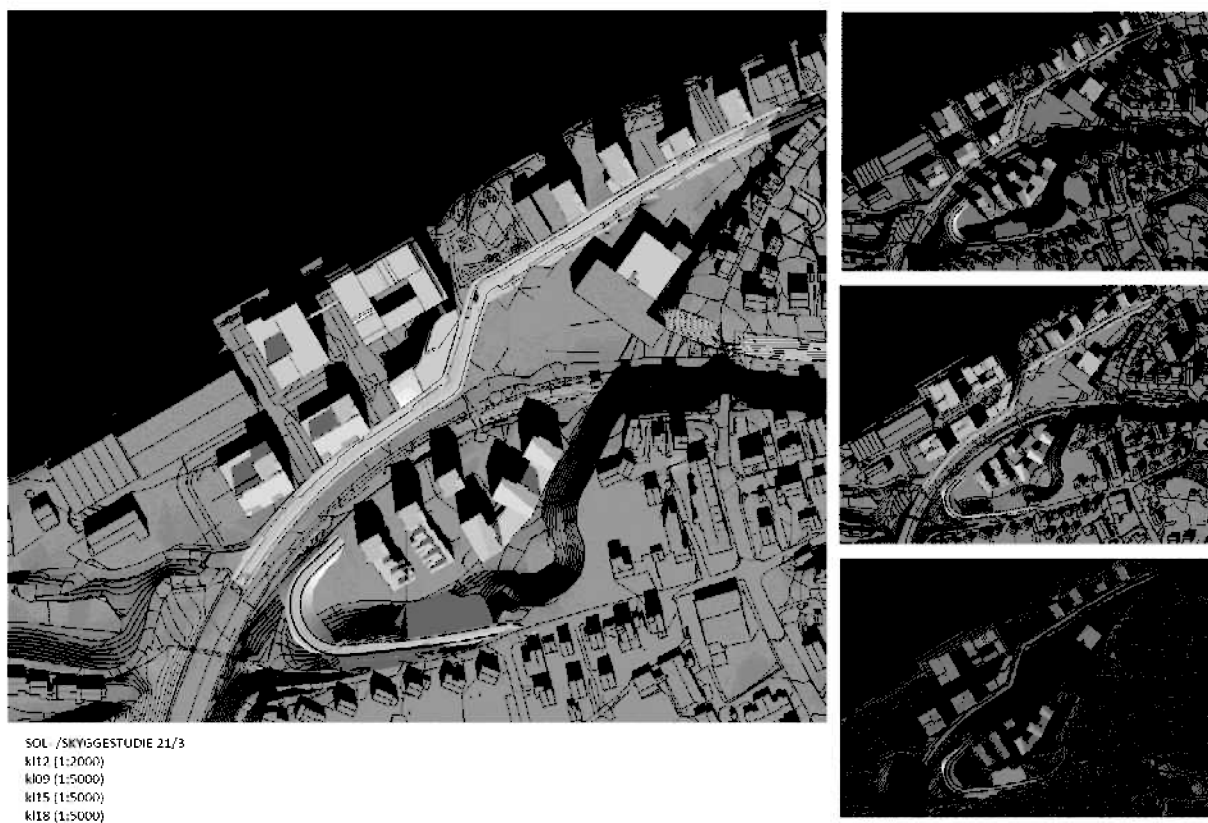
Planforslaget legger opp til ny bebyggelse i Strandgata, Stokkekaia og Troa. Boligområdet på Troa til høyre på illustrasjonen er etter høring tatt ut av planen.
